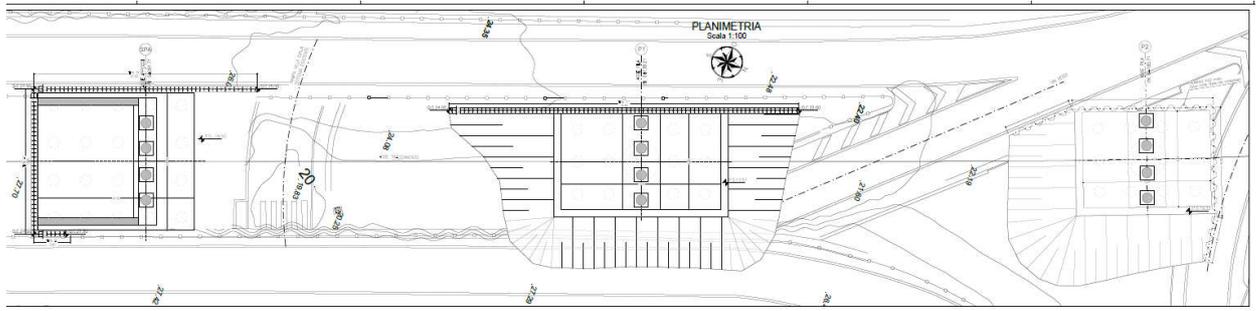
Planimetria opere provvisorie spalla A e pila 1
